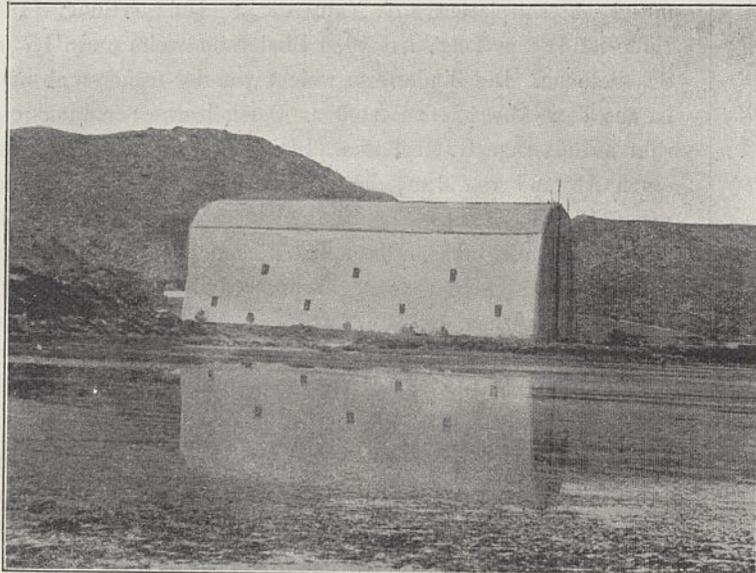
Versetzbare einschiffige Halle in Eisen.
